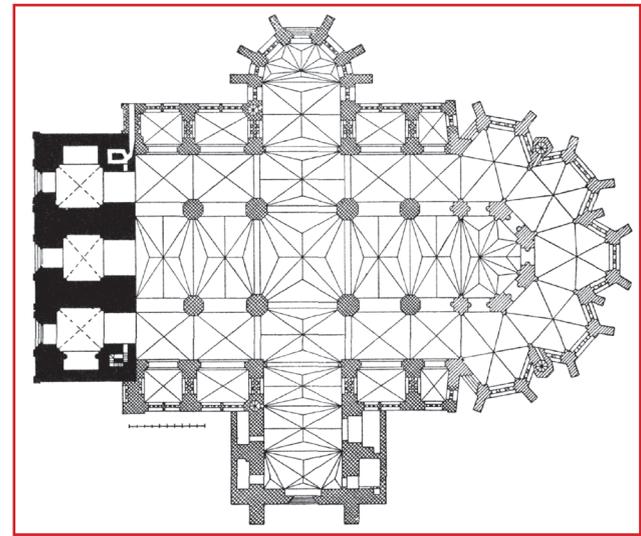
Grundriss der Marienkirche in Rostock (nach Georg Dehio)
